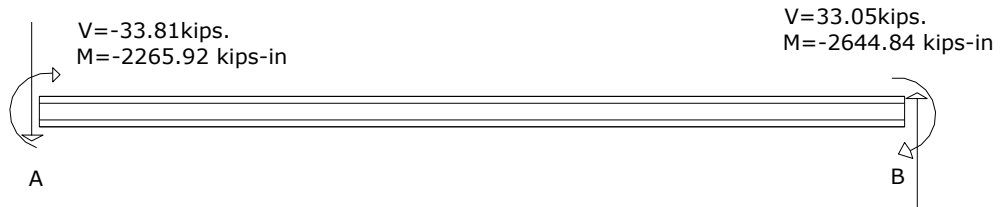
Acciones internas en las conexiones de la viga A-B.
